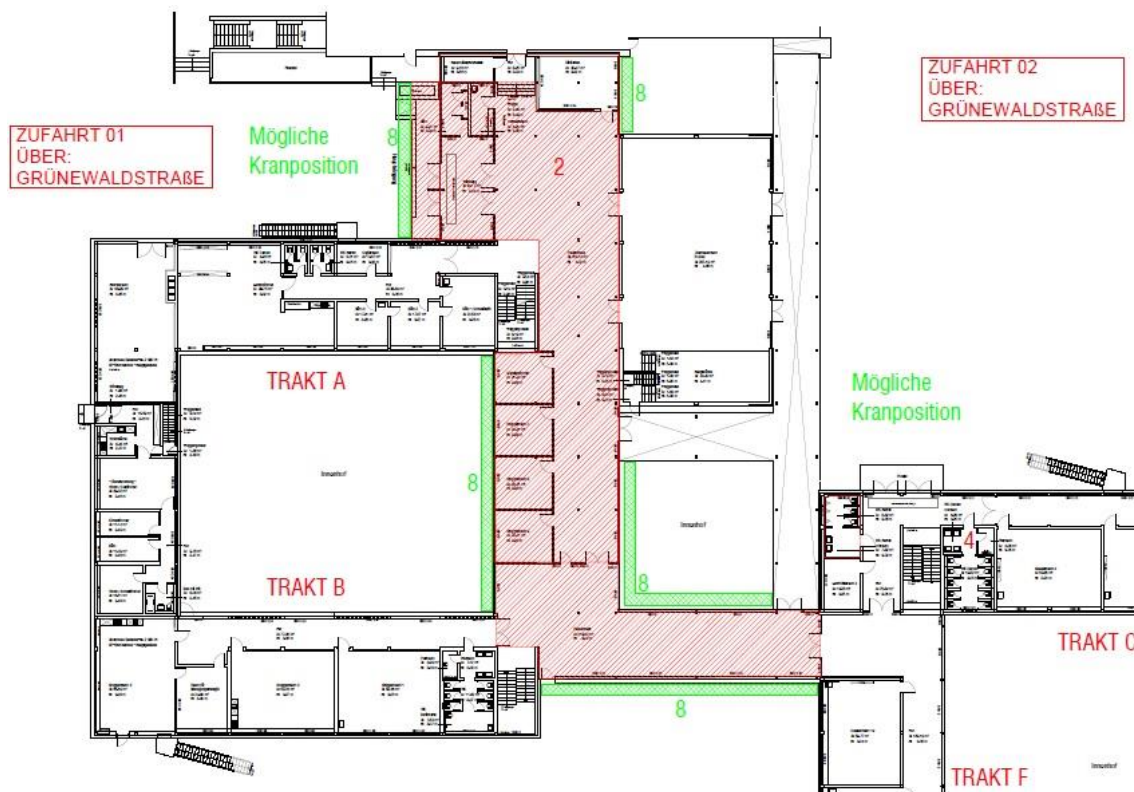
Grundriss Verbindungsbau (Sanierte Bereich ist rot markiert).
